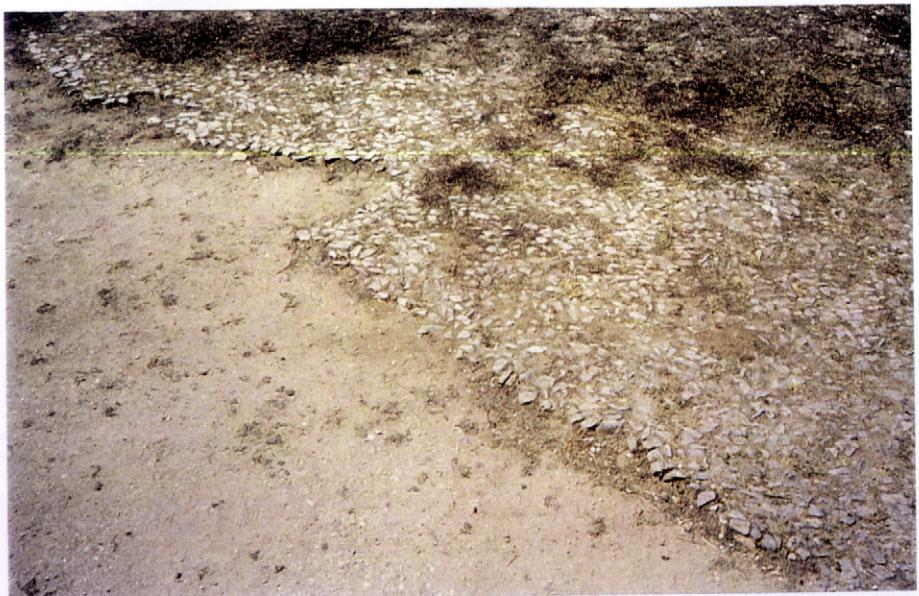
Plataforma do reparo / Fachada Norte – Setembro de 2000.
